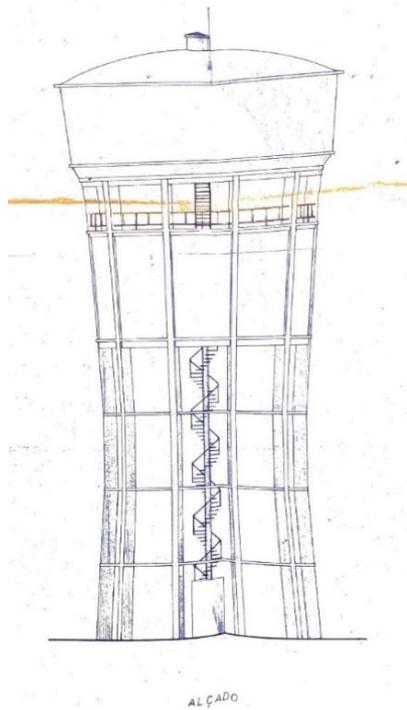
Alçado do Depósito Duplo de Betão Armado para Água Doce e Salgada que a CUF construiu no Bairro Operário.
